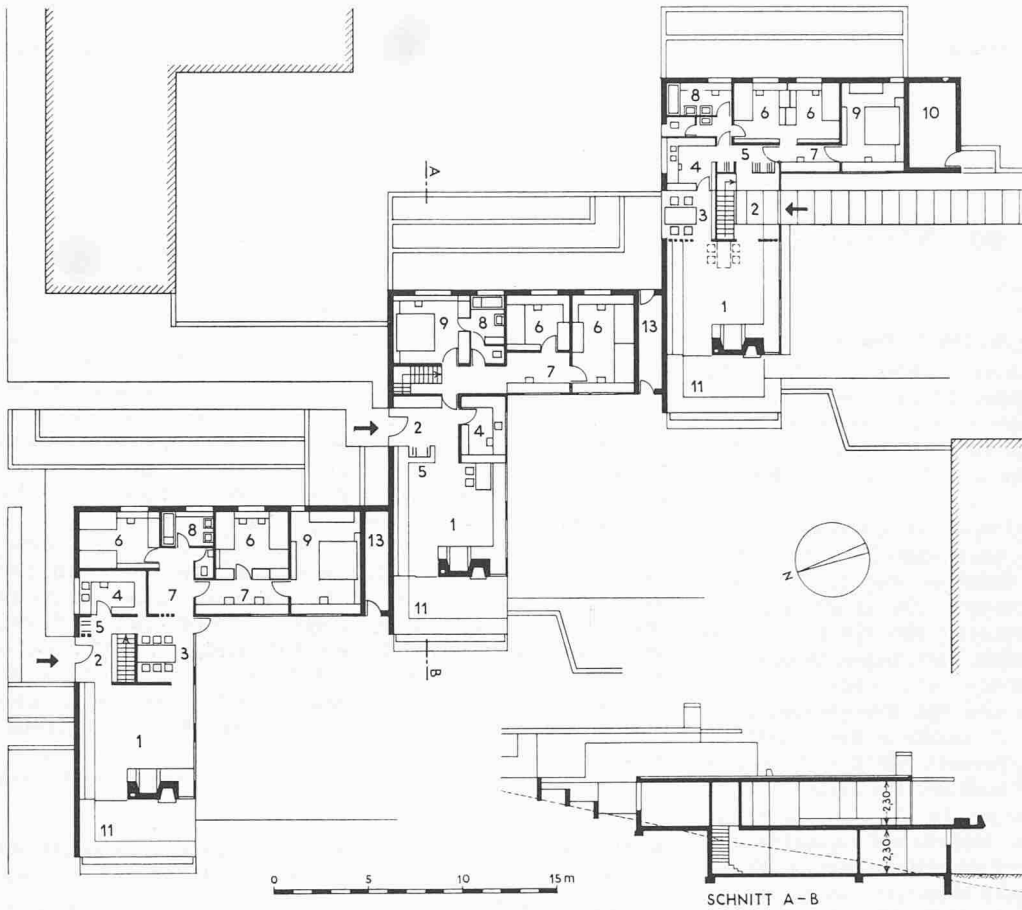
Hangüberbauung an der Burgstrasse in Winterthur-Wülflingen mit individuellen Grundrissen entsprechend den Bedürfnissen der einzelnen Familien. Erdgeschossgrundriss 1:400 und Querschnitt A-B durch Wohn- und Arbeitsräume (gegen rechts ein breit auskragender Balkon vor dem gross dimensionierten Wohnraum)
